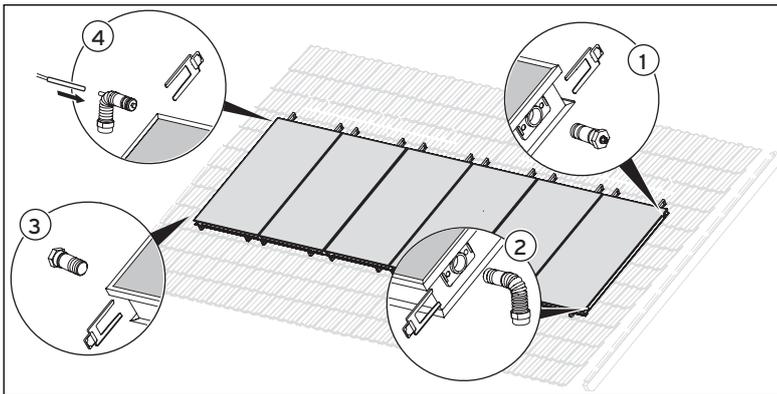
Montaggio dei collegamenti idraulici (6 o più collettori)
